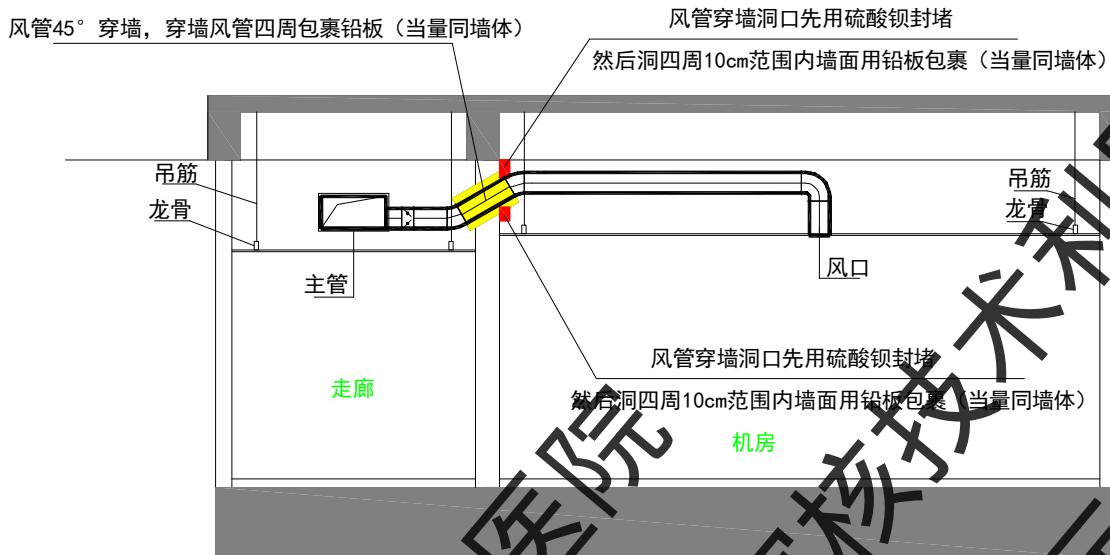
直线加速器机房风管穿屏蔽墙剖面图
